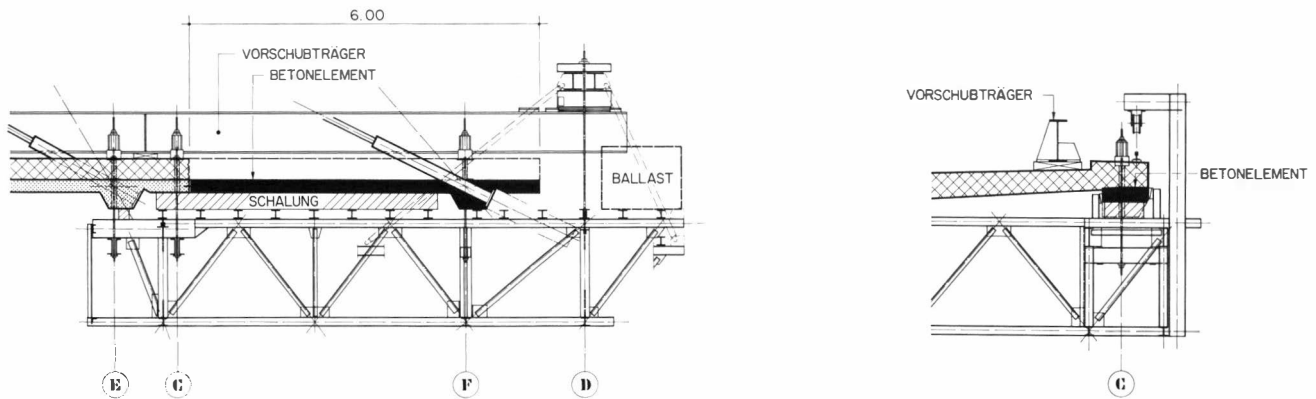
Vorbauwagen (Längsschnitt, Teilquerschnitt) – Chariot de lancement (section longitudinale, coupe en travers partielle) – Launching car (longitudinal section, part of cross section)
